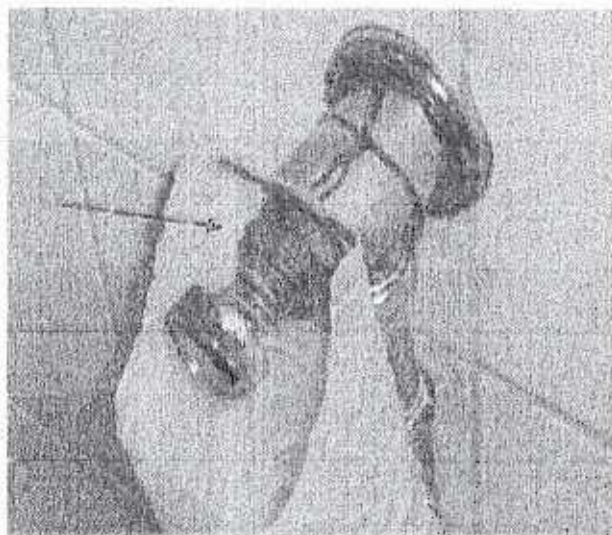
Falta de cerradura y picaportes en mampara de acceso.
